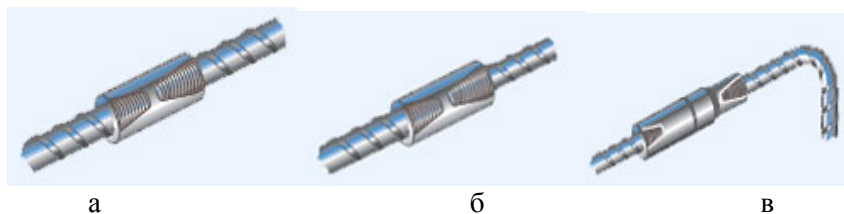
Типы муфт для соединений арматуры LENTON:
